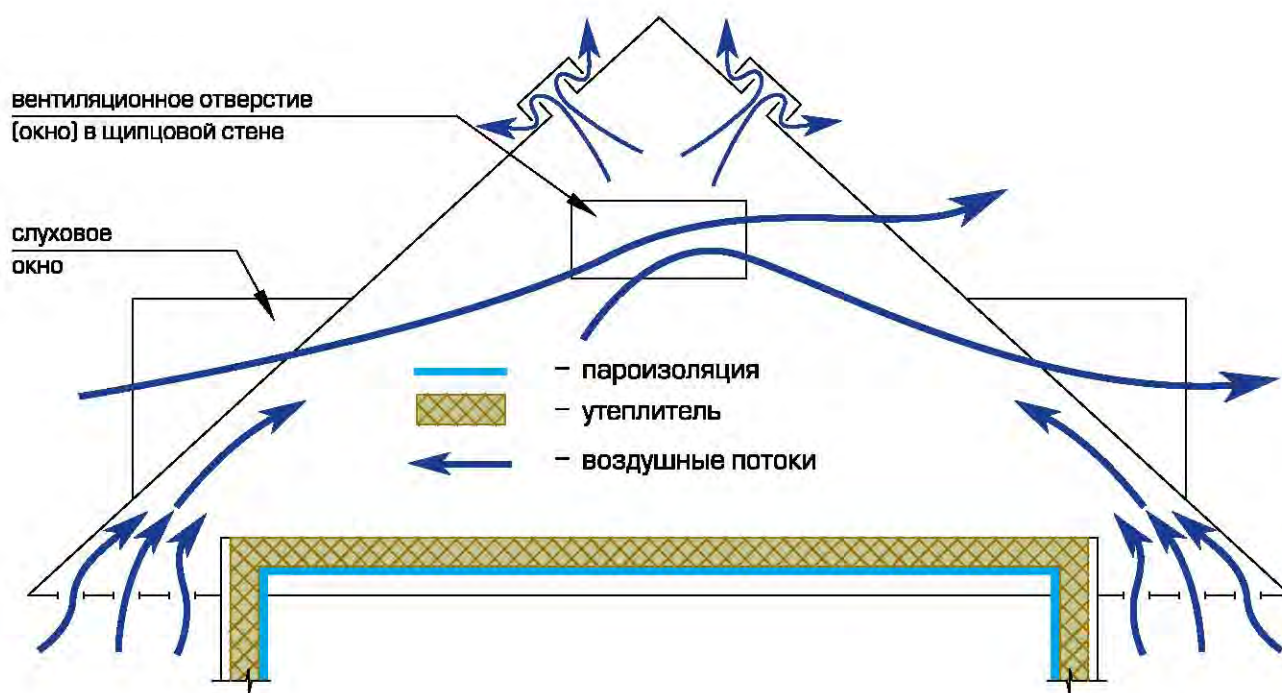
Схема утепления, пароизоляции и вентиляции нежилого чердачного помещения
